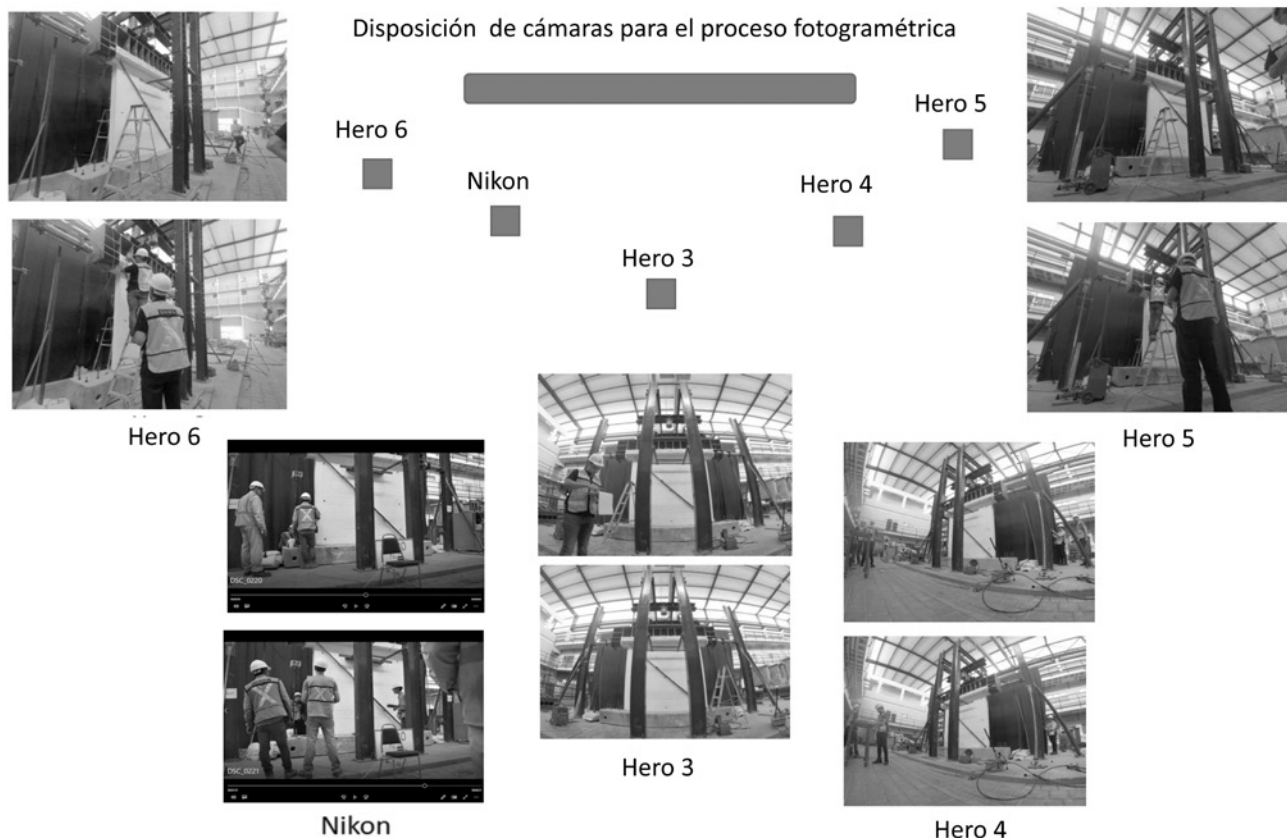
Control fotogramétrico del comportamiento de un muro de mampostería ensayado a carga cíclica reversible.
